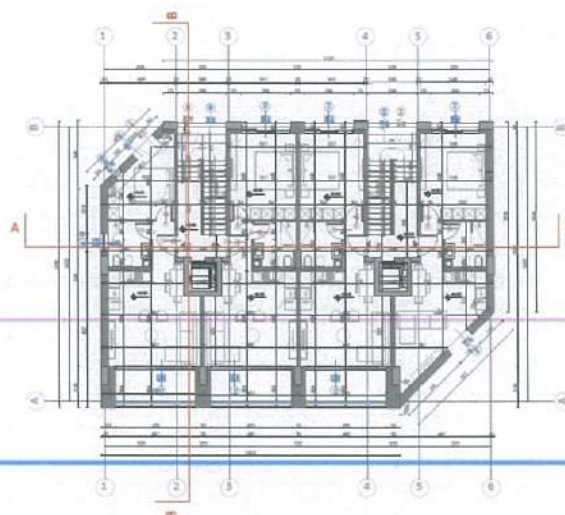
Planimetria e katit përdhe, Objekti 7, Prona Veriore
